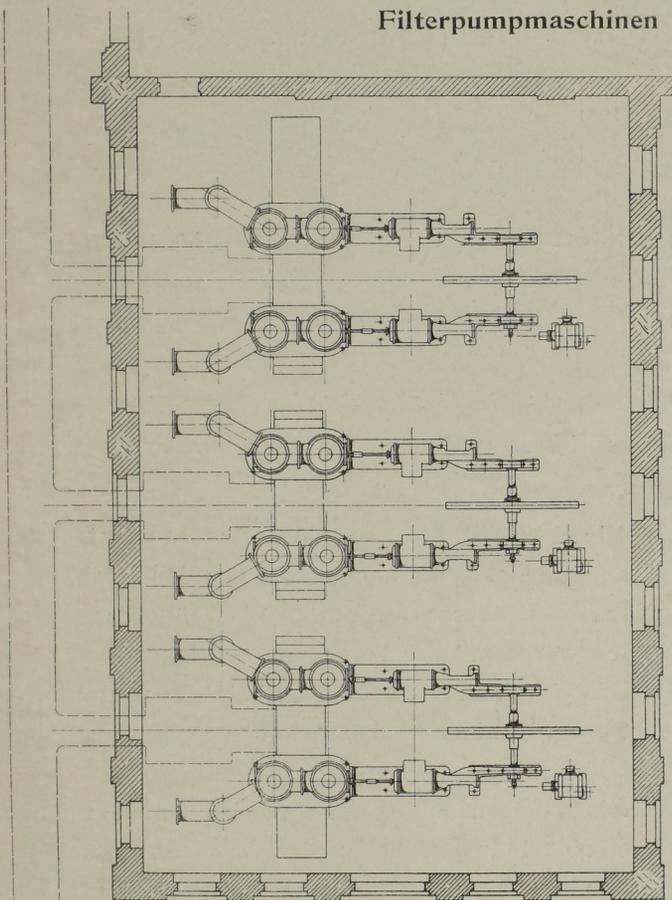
Grundriss der Filterpumpen-Anlage. Masst. 1:200.
